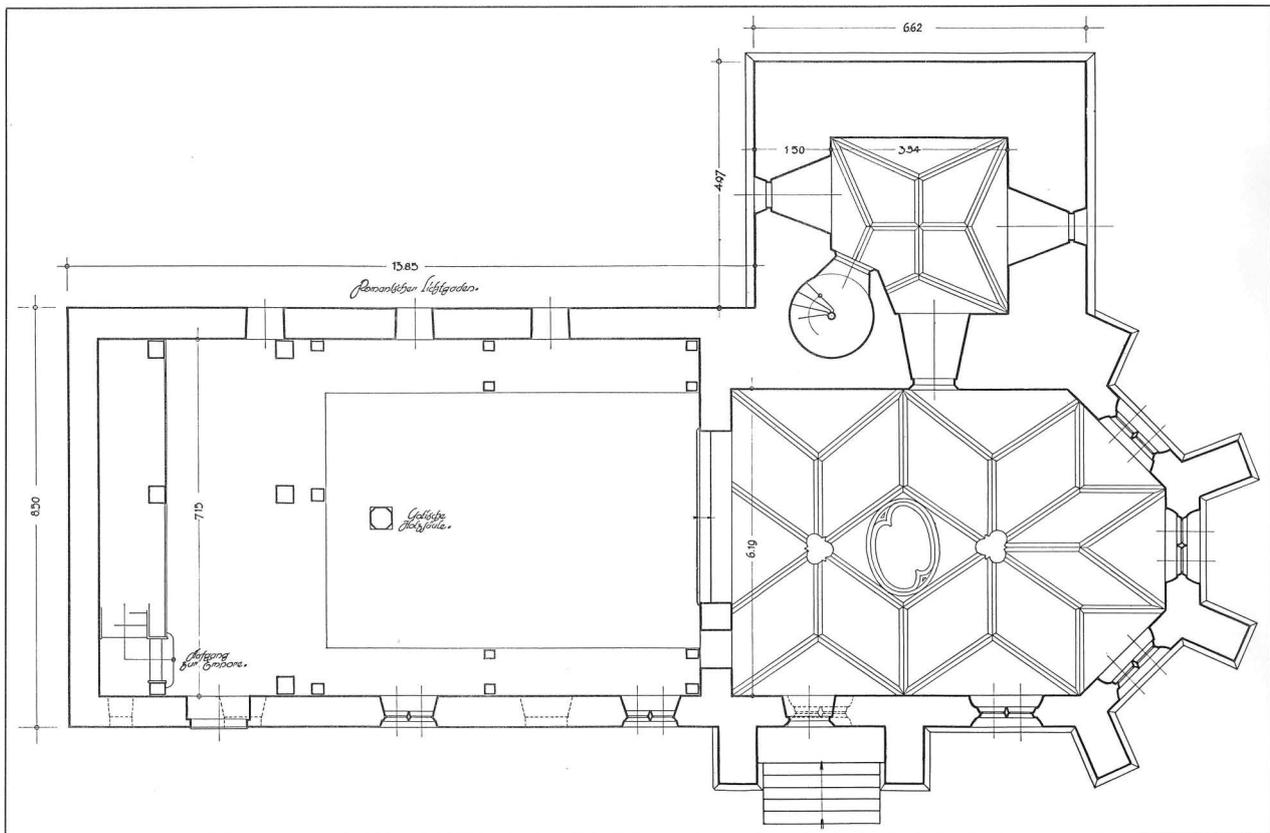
Niederhausen. Pfarrkirche; Grundriß
